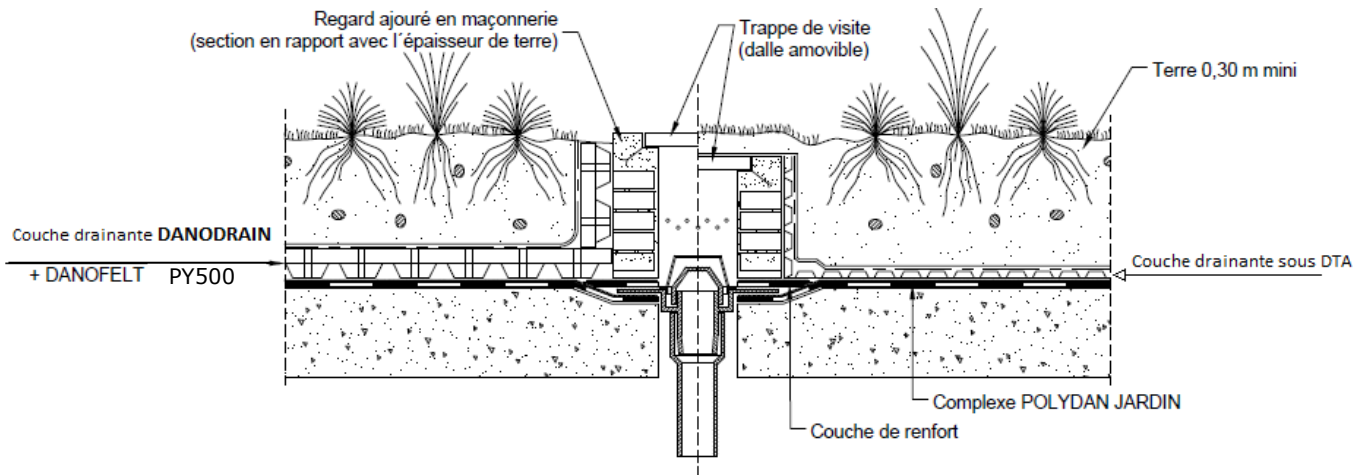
Exemple d'évacuation pluviale – Toiture-terrace-jardin - Élément porteur en maçonnerie
